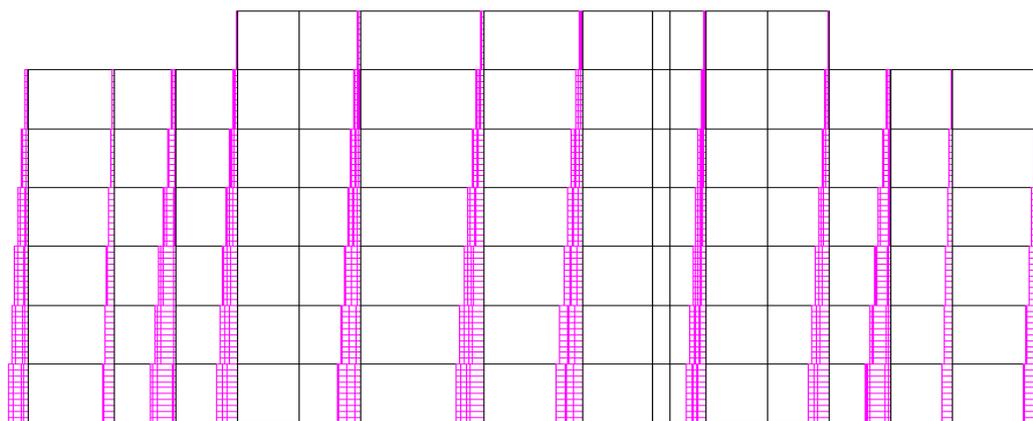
Эпюры продольных усилий N в колоннах.
